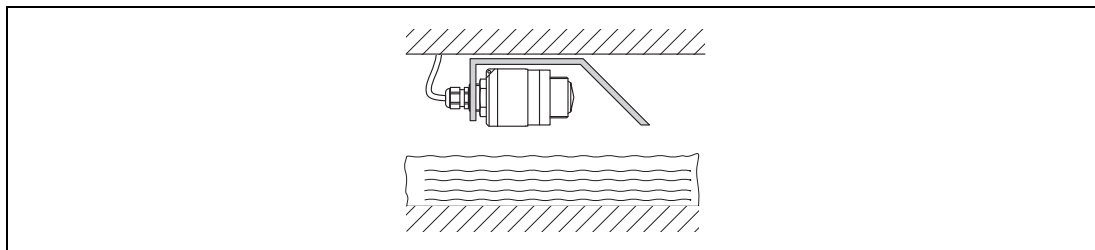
Montage horizontale Montagehalterung Abwasserschacht
